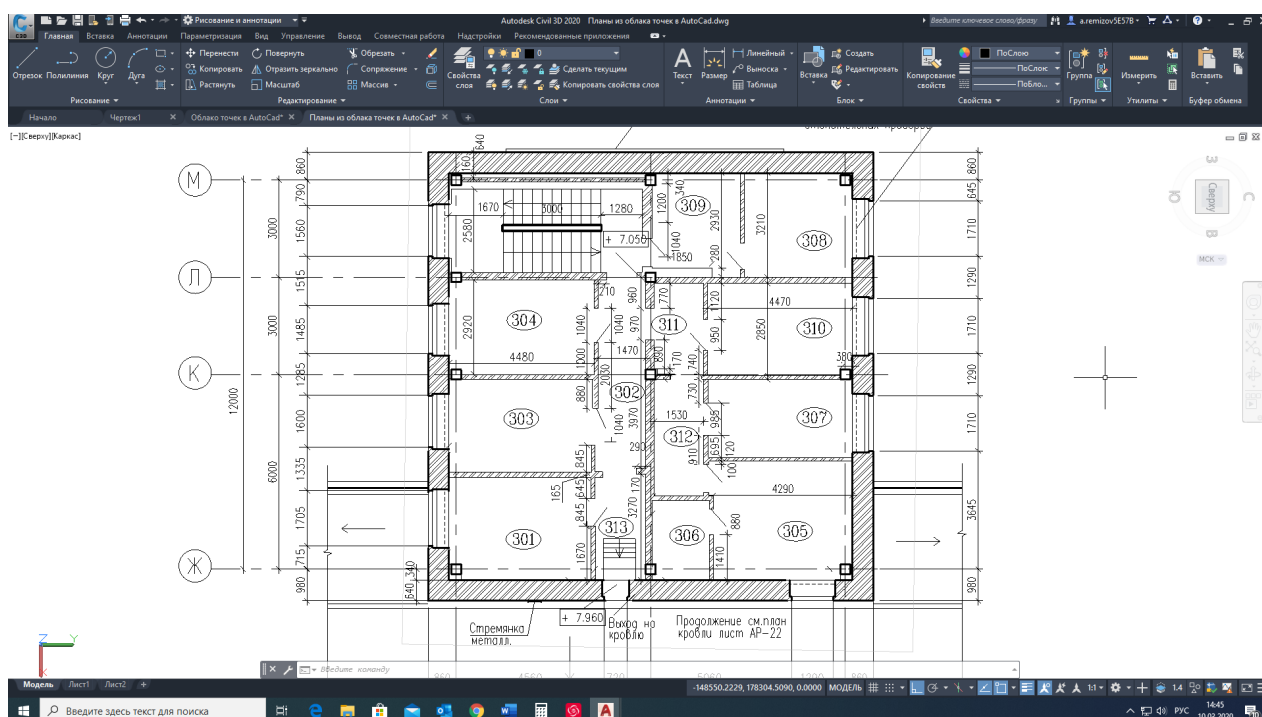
План этажа в AutoCAD, созданный по массиву точек
